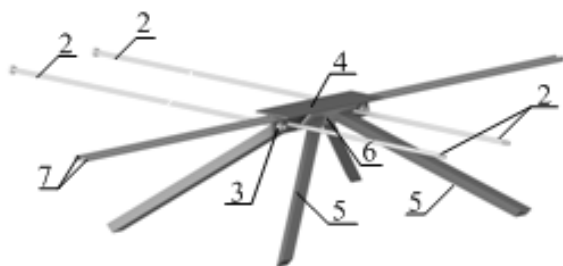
Металлический каркас предлагаемой конструкции пролетного строения
